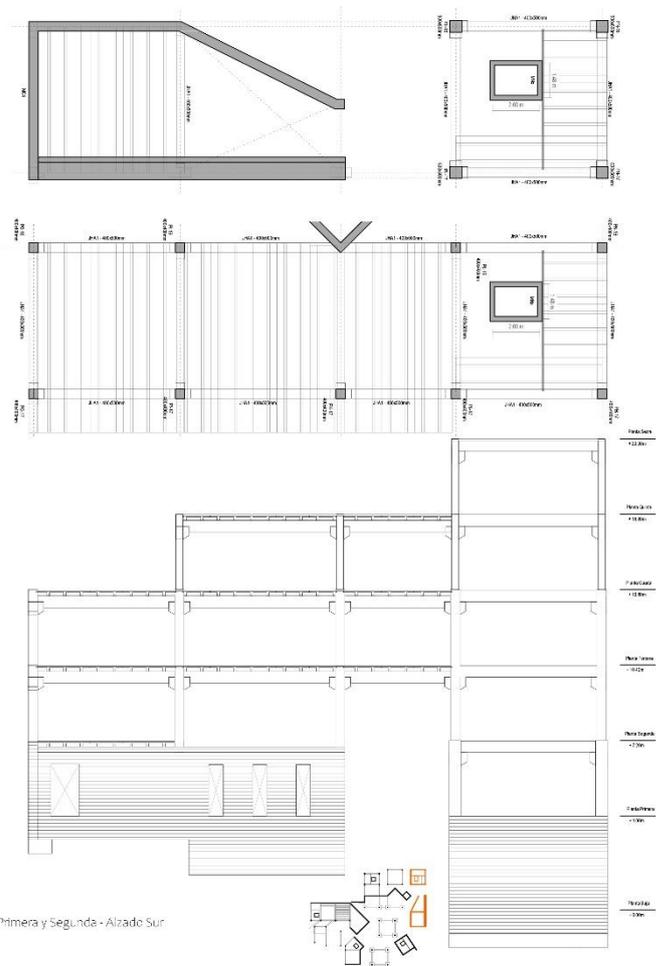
Axonometría Estructural - Techo Planta Primera y Segunda - Alzado Sur
